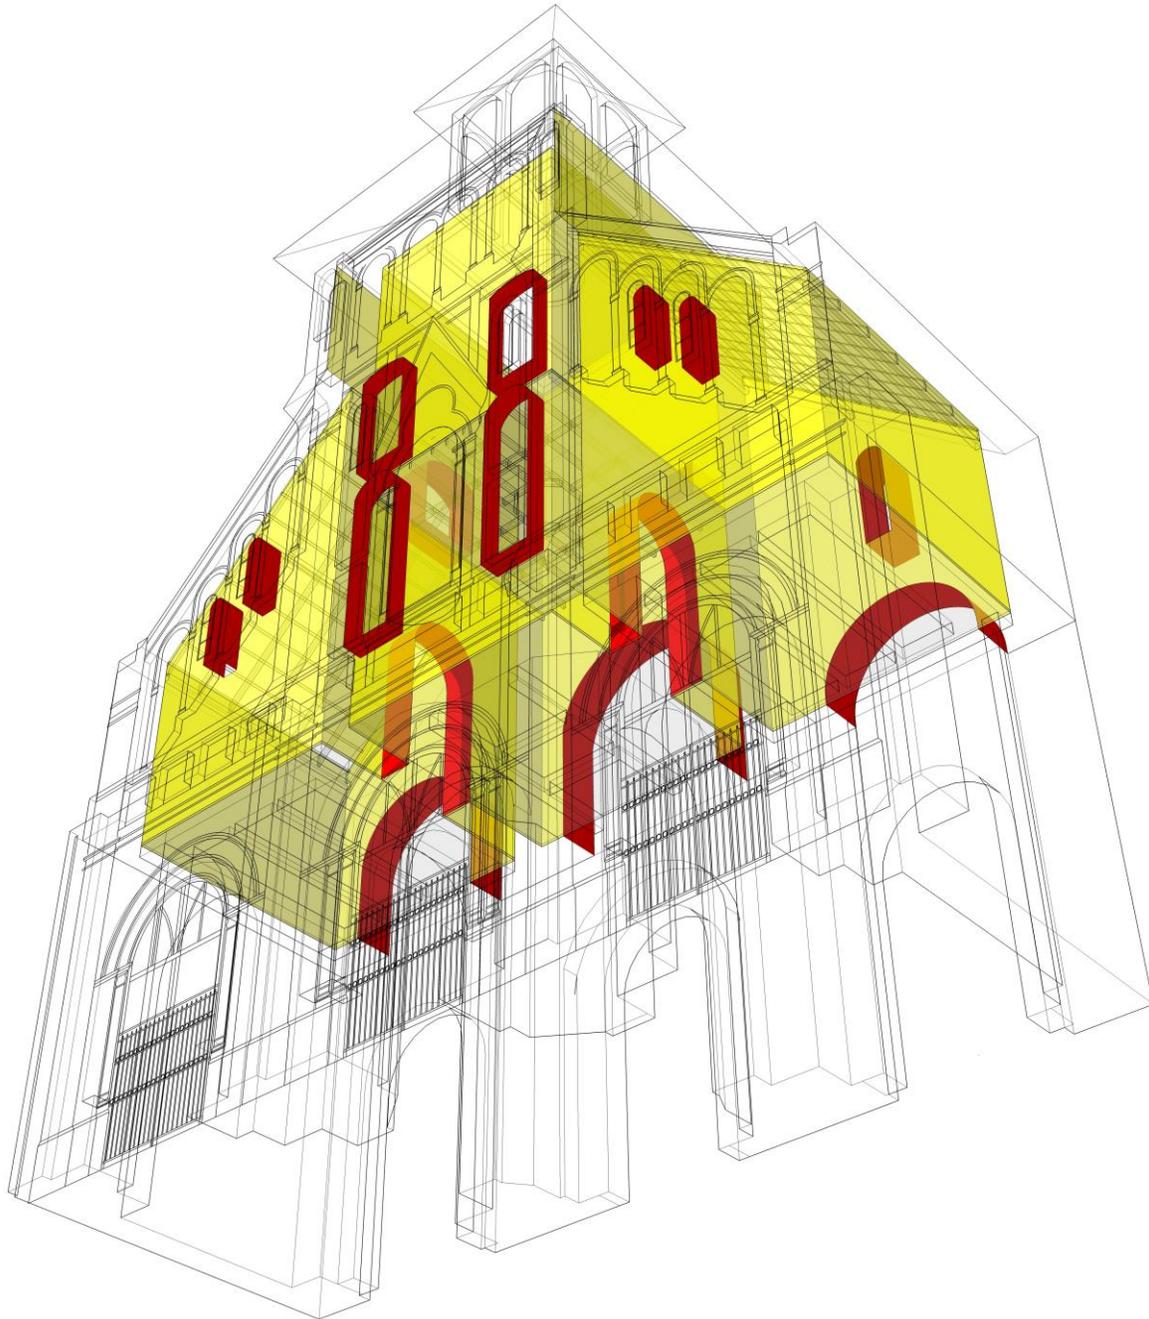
Esquema isométrico de propuesta de consolidación interior de volumen frontal. En amarillo caras consolidadas mediante mallas y en rojo arcos y vanos reforzados con pletinas metálicas. Elab, propia.
